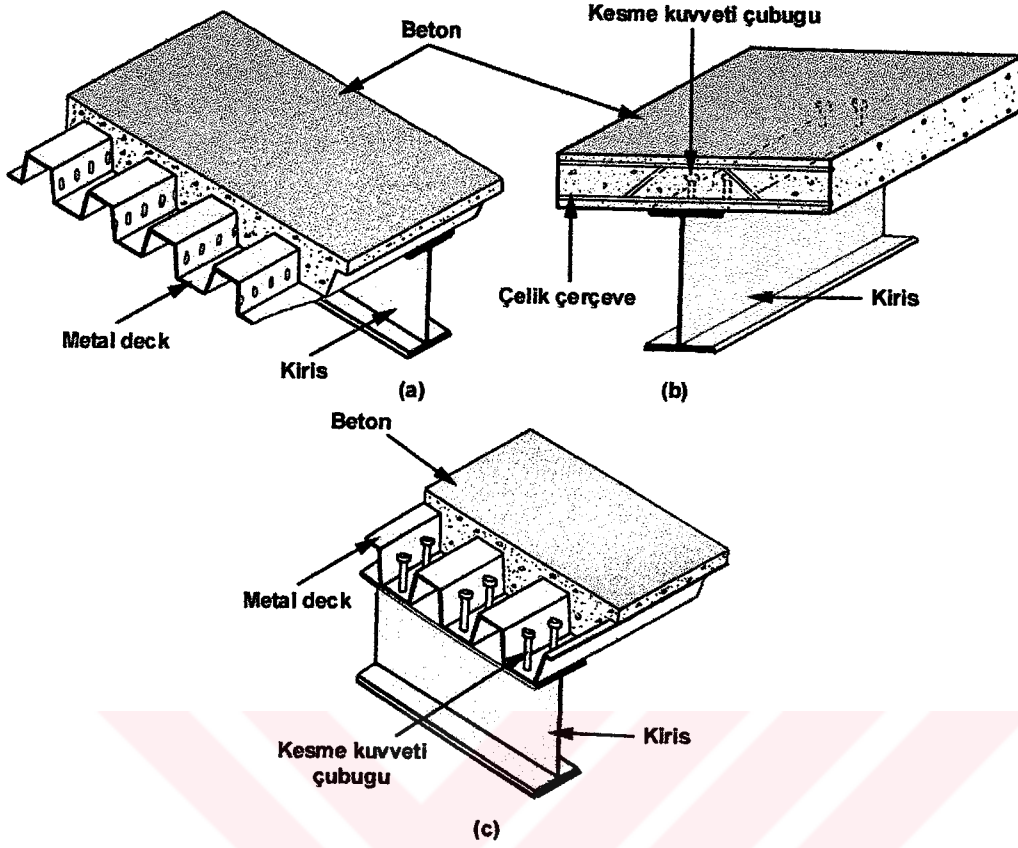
Çelik taşıyıcı sistemlerde, üç yönlü kiriş sistemleri (nervürlü döşemeye benzer bir sistem).
